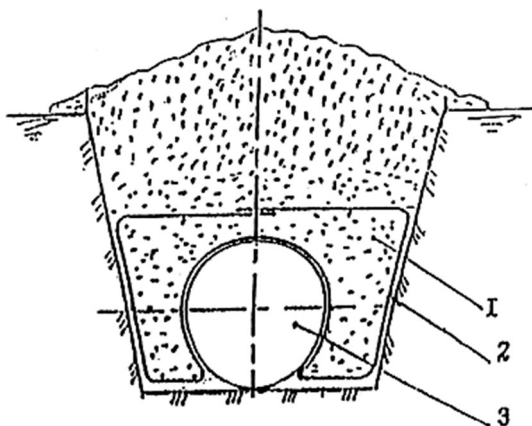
Вариант закрепления нефтегазопроводов минеральным грунтом засыпки с применением полотнищ из НСМ. 1– грунт засыпки; 2 – полотнище из НСМ; 3 – трубопровод.
